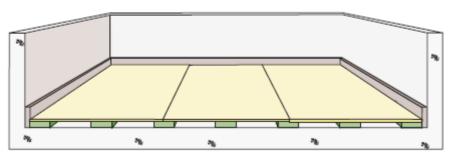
Pose des panneaux de coffrage sur les isolateurs acoustiques et fixation en place.
